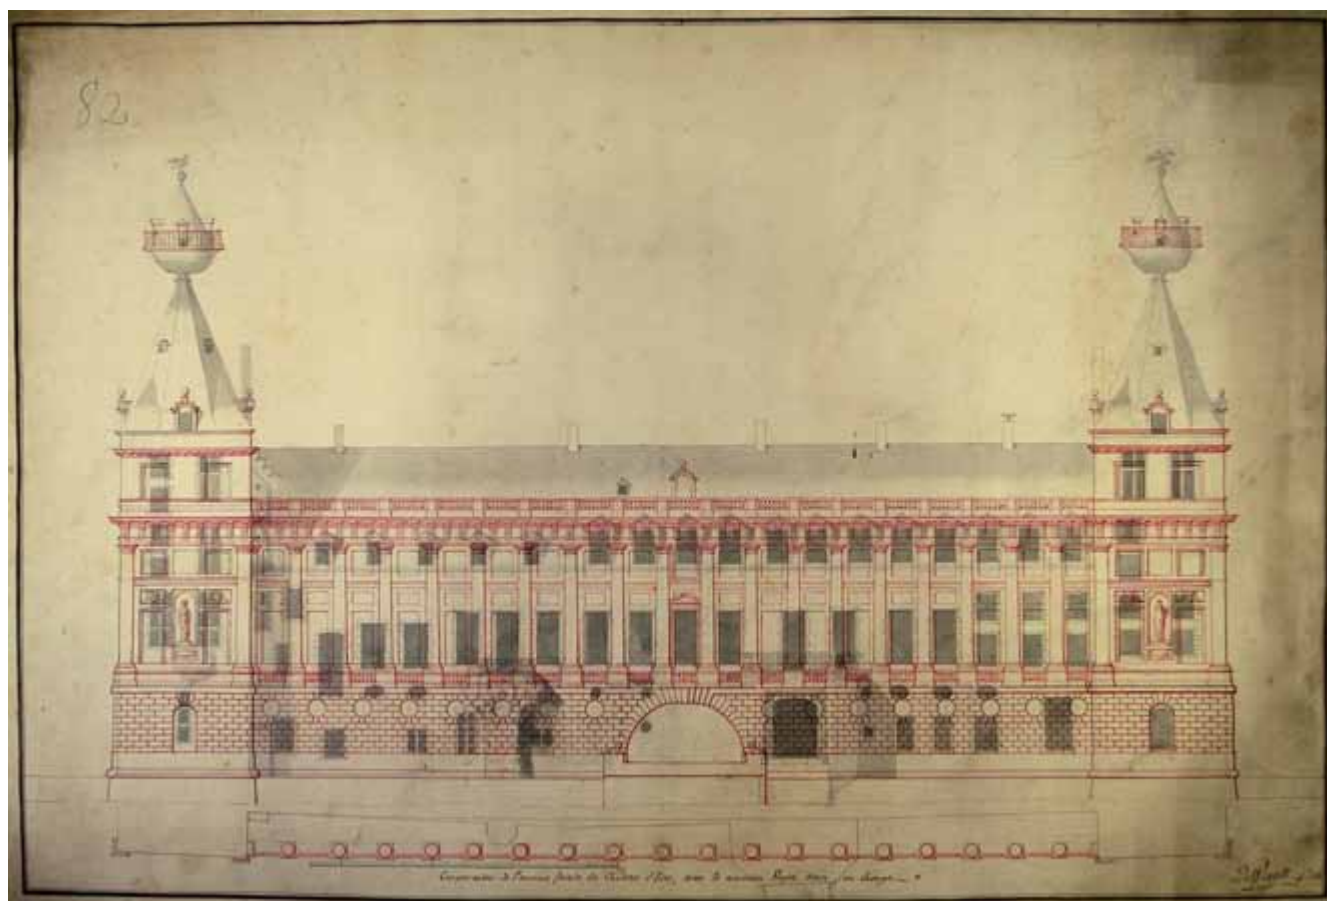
Projet pour la façade du château d'Heverlee, en surcharge rouge sur l'ancienne façade (Archives Générales du Royaume).
